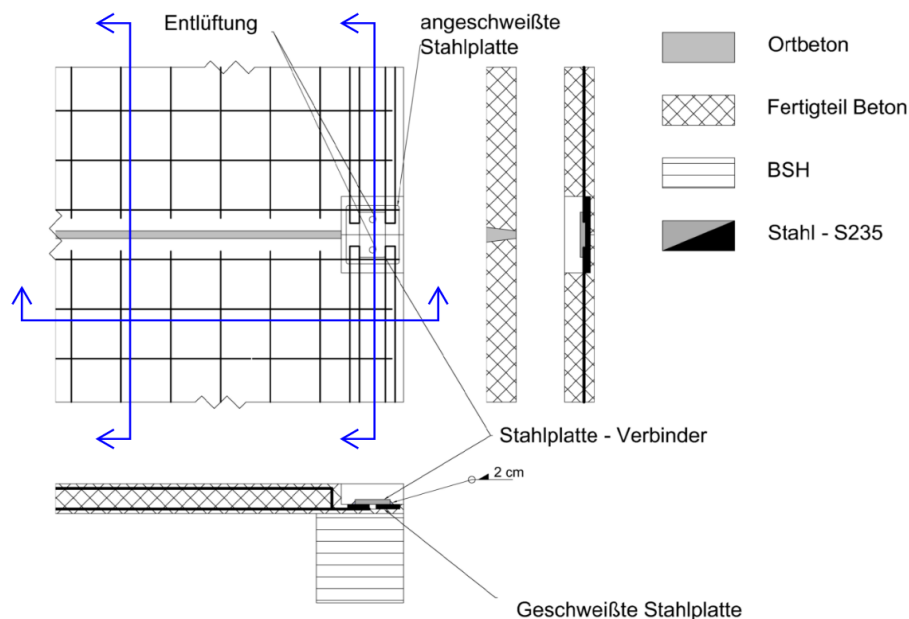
Grundriss und Schnitte: Stahlbauverbindung zur Kopplung der Fertigteile
